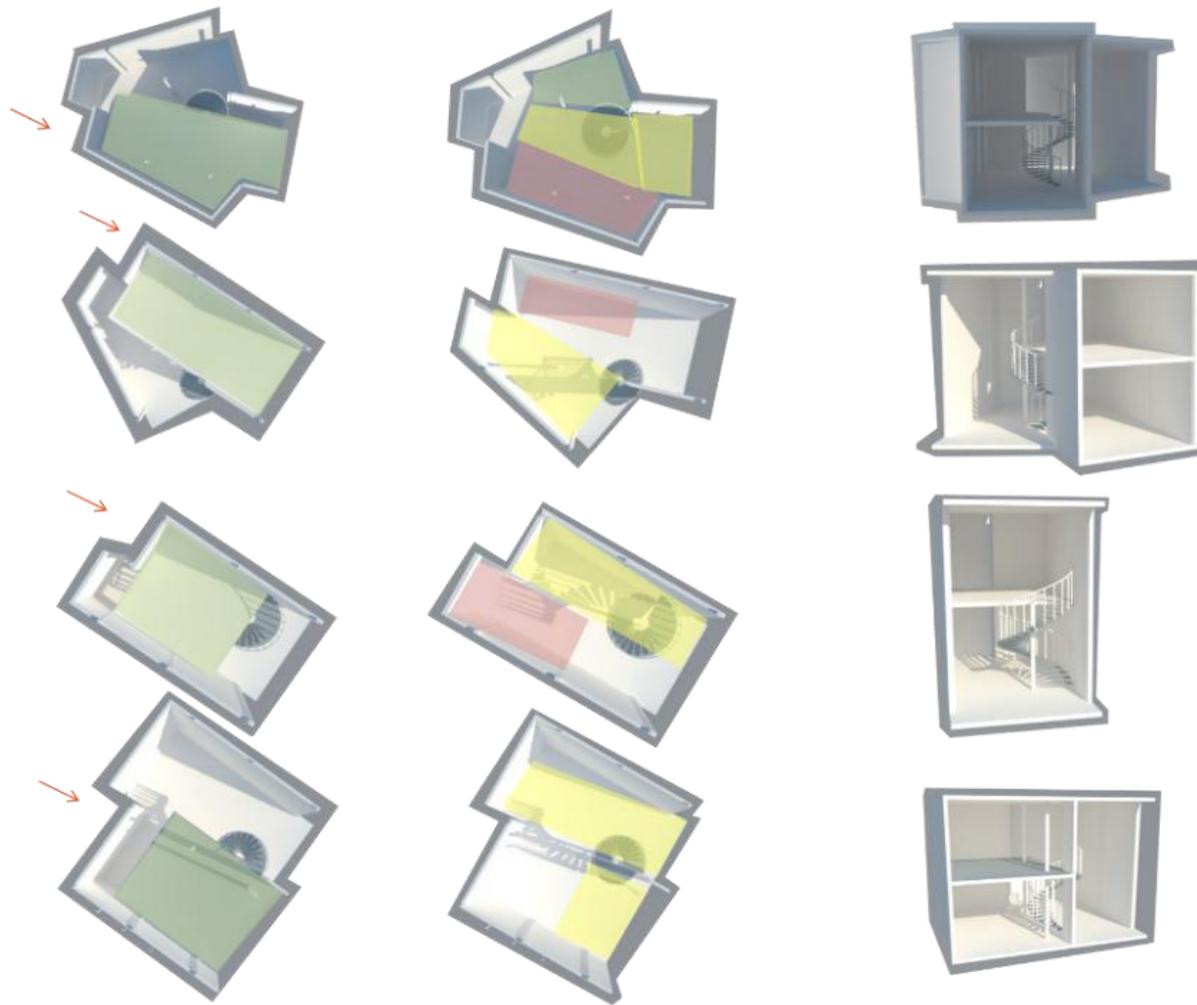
Unidad de vivienda. Parque sucre, Girardot. Elaboración propia
